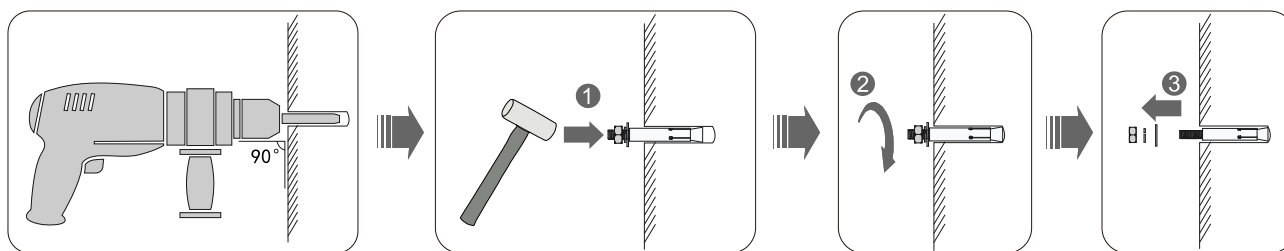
Einschieben der Schrauben in die Bohrlöcher
